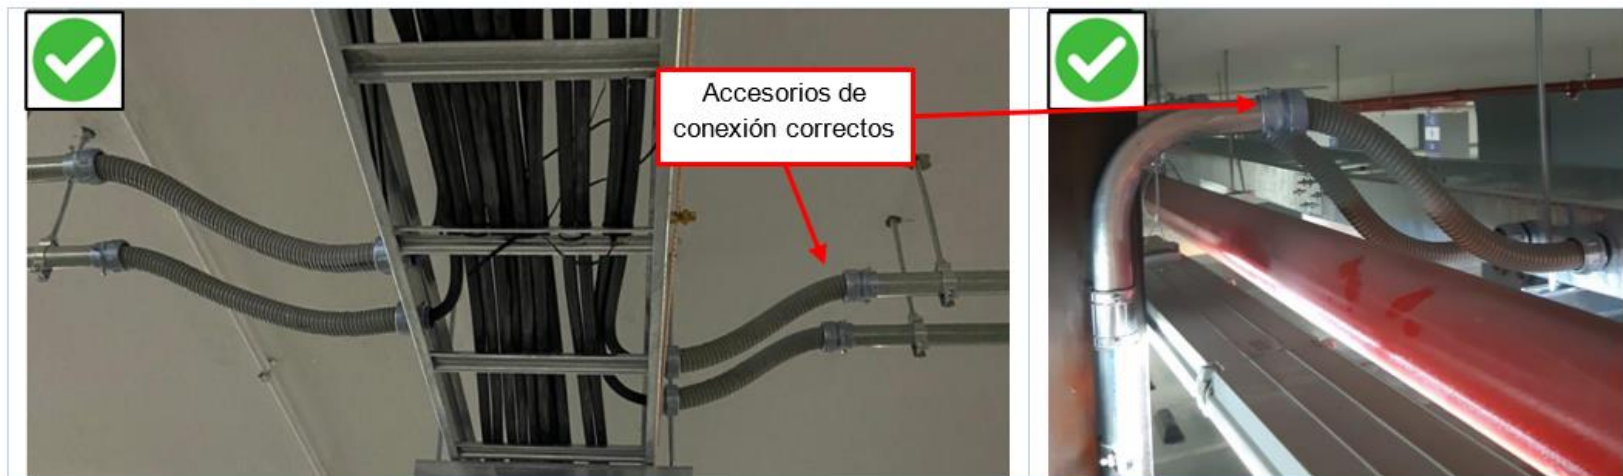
Buenas prácticas en tuberías metálicas flexibles.
